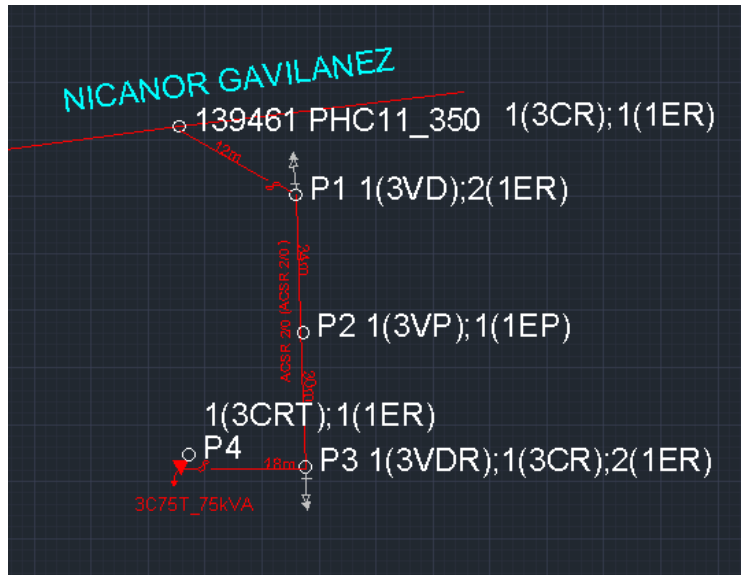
Extensión de red MV y montaje de transformador 75 kVA
